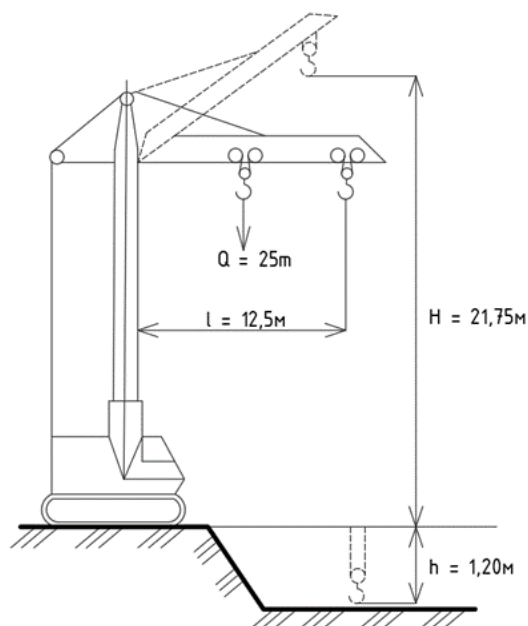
Схема обраного крану для фундаментів
